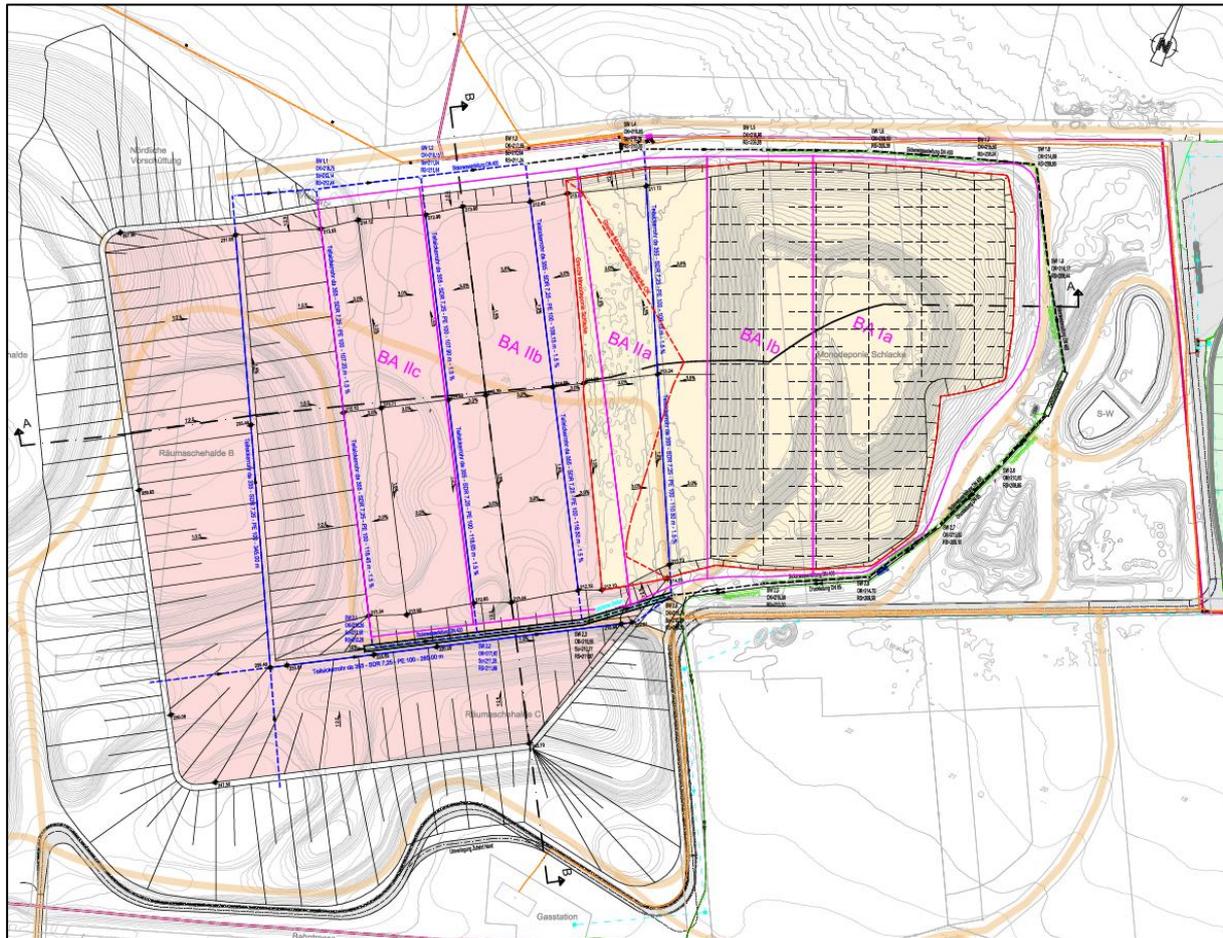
Lageplan Erweiterung DK I-Deponie
